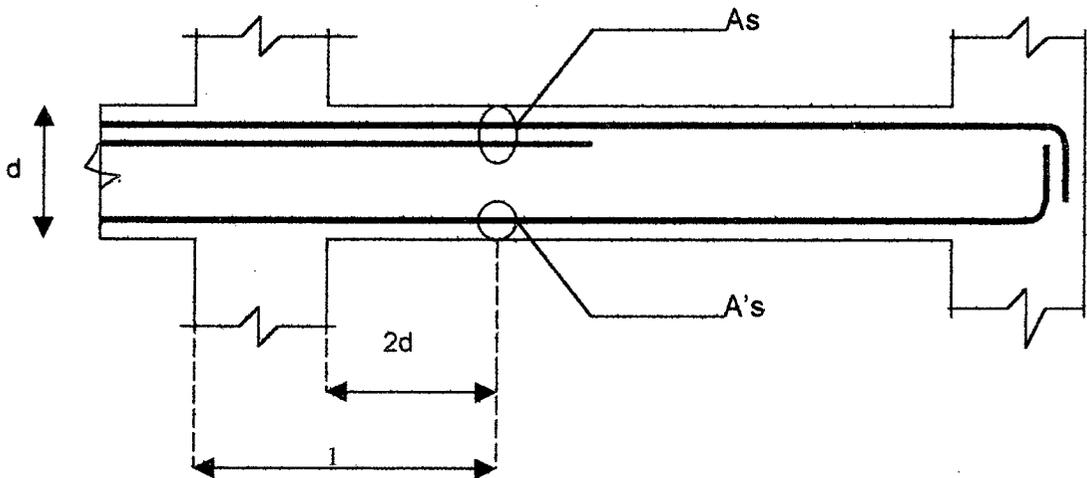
c.2 Requisitos para el refuerzo longitudinal de vigas de concreto
